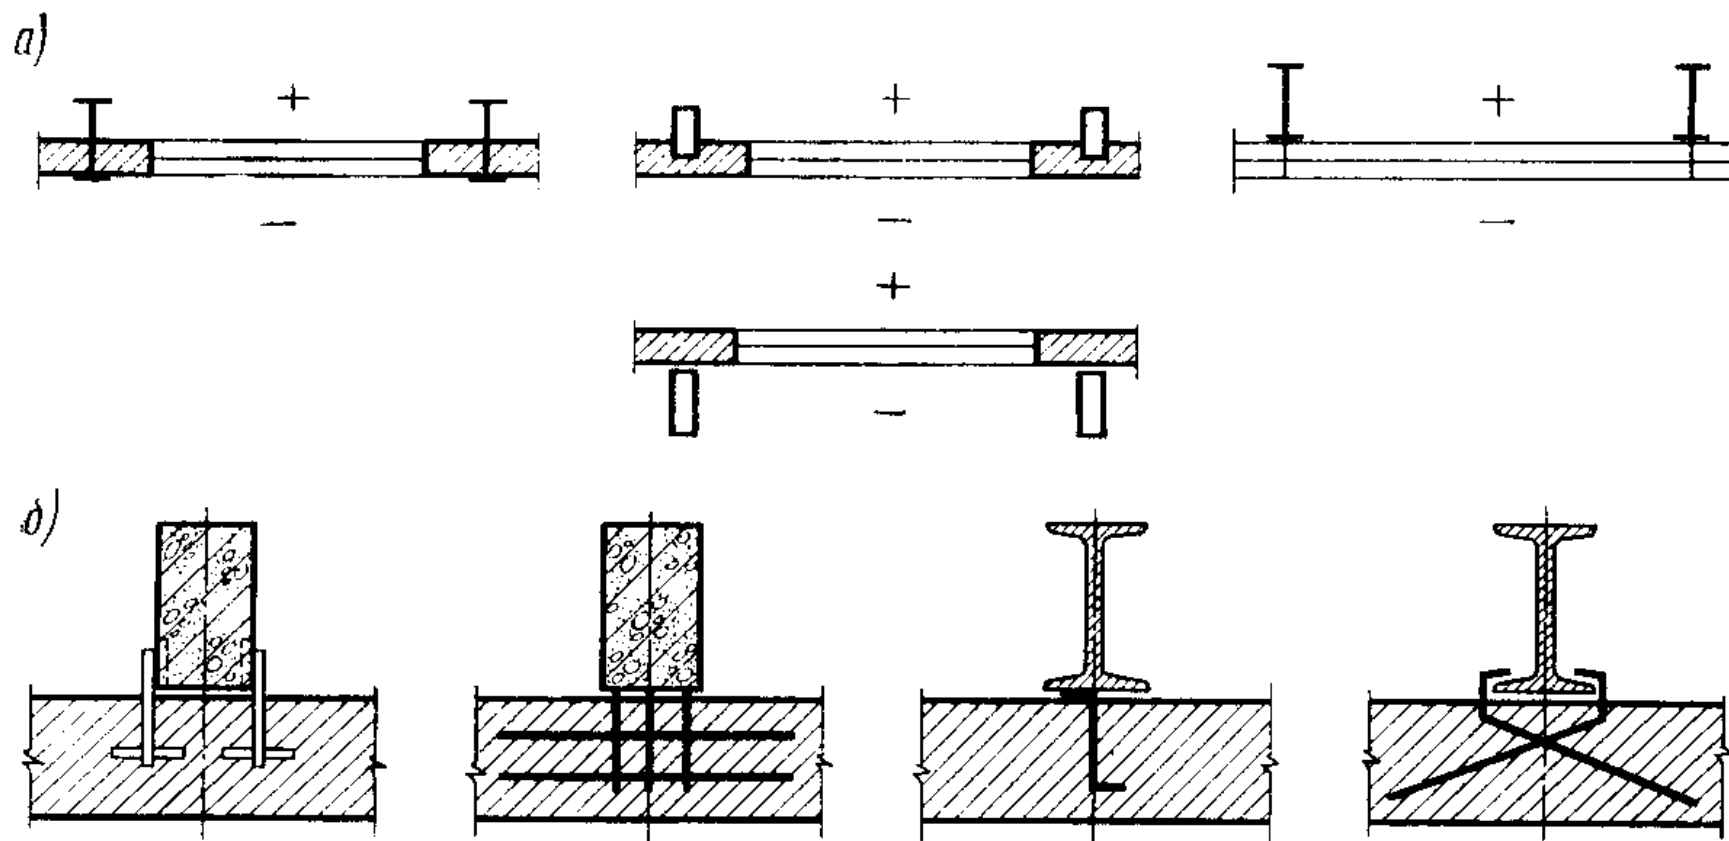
Схеми стін із цегли: а - розміщення; б – кріплення до колон
